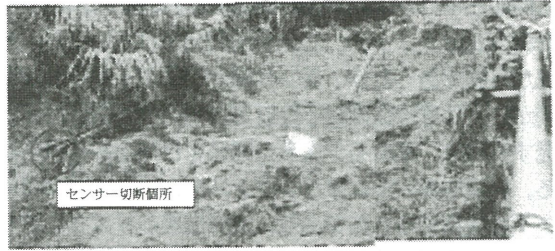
崩壊個所の状況 (NO. 22-23 地点)
